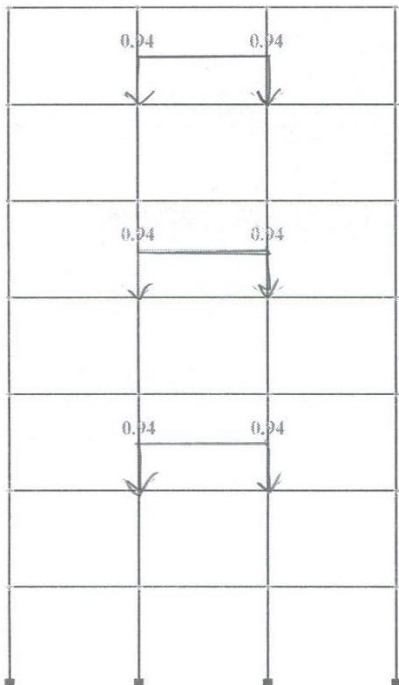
Схема завантаження рами у середньому прольоті по нечотним поверхам навантаження від людей та устаткування.
